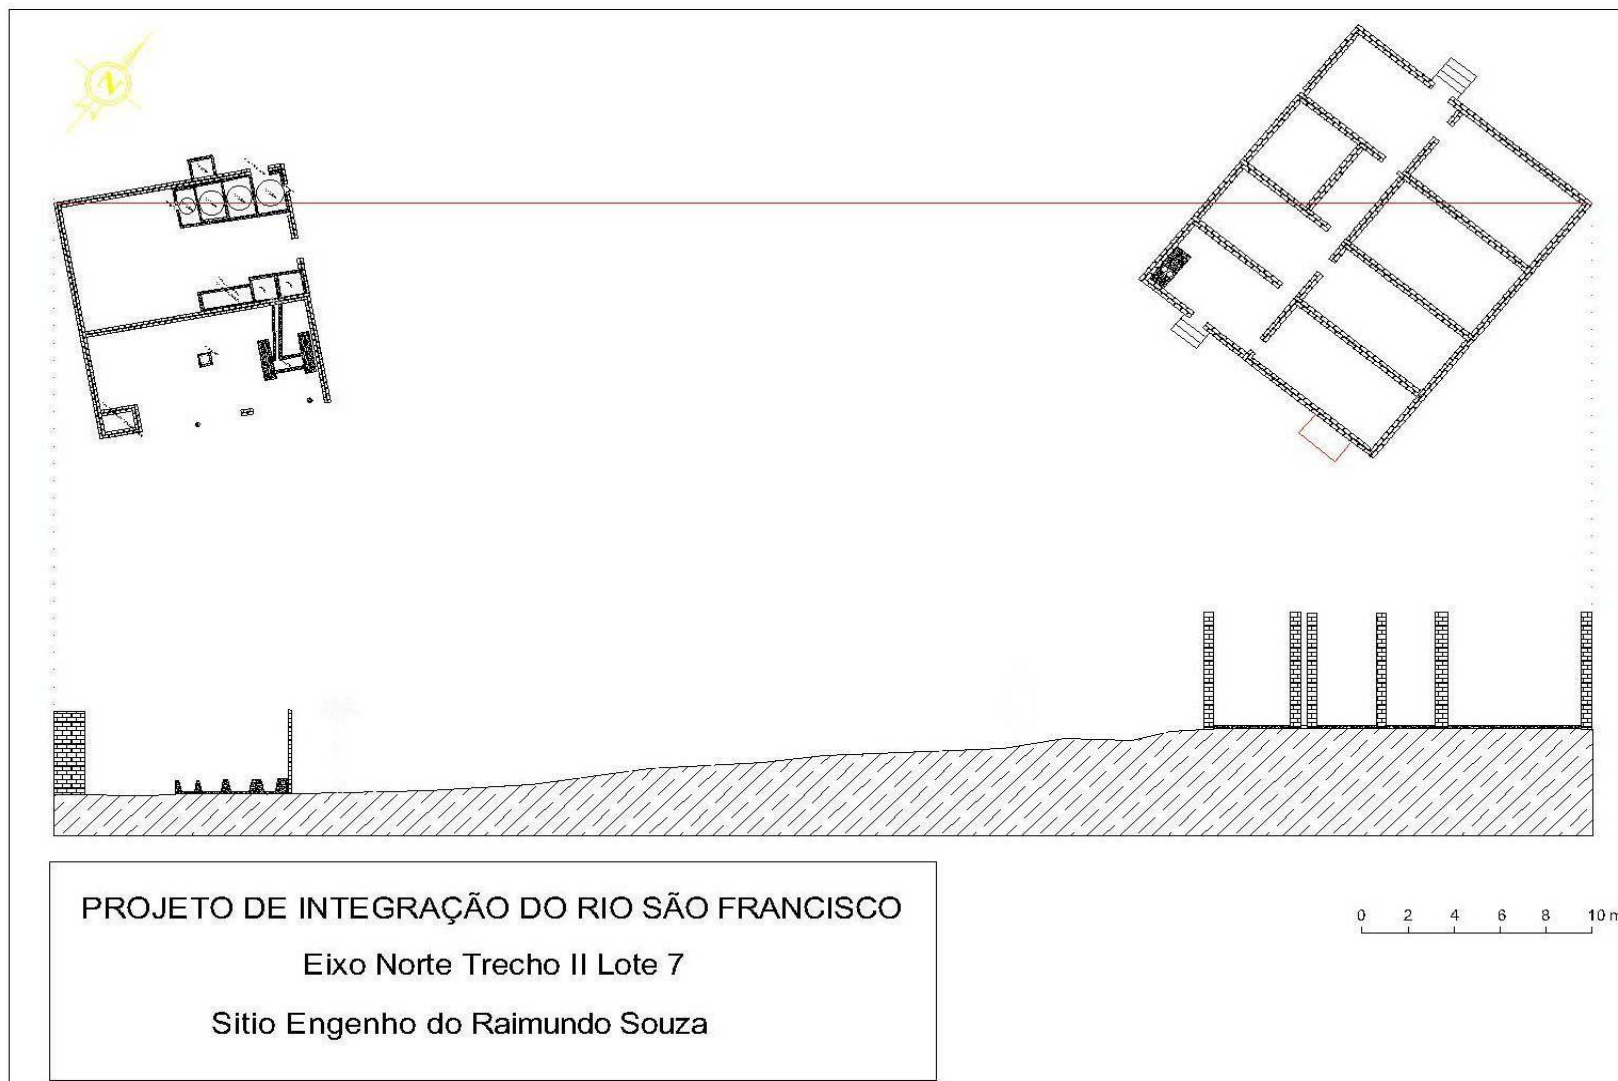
Planta do engenho do Raimundo Souza.
